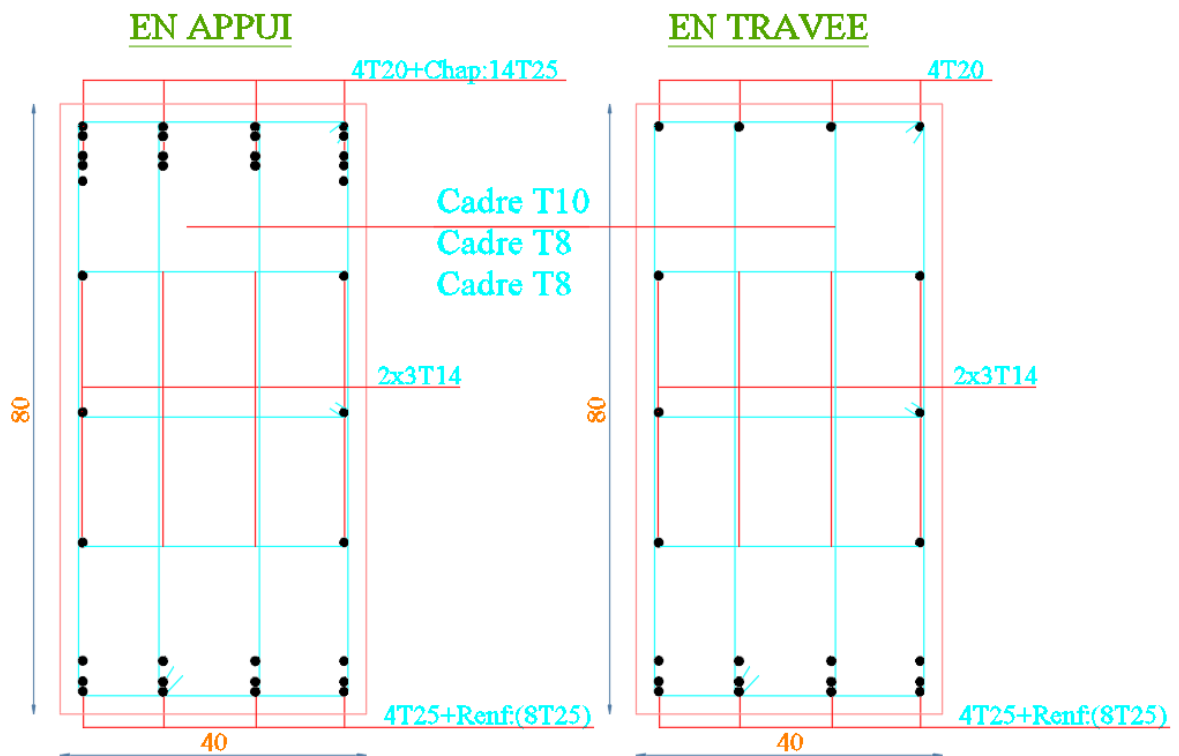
Schéma du ferrailage de la poutre principale 40*80
